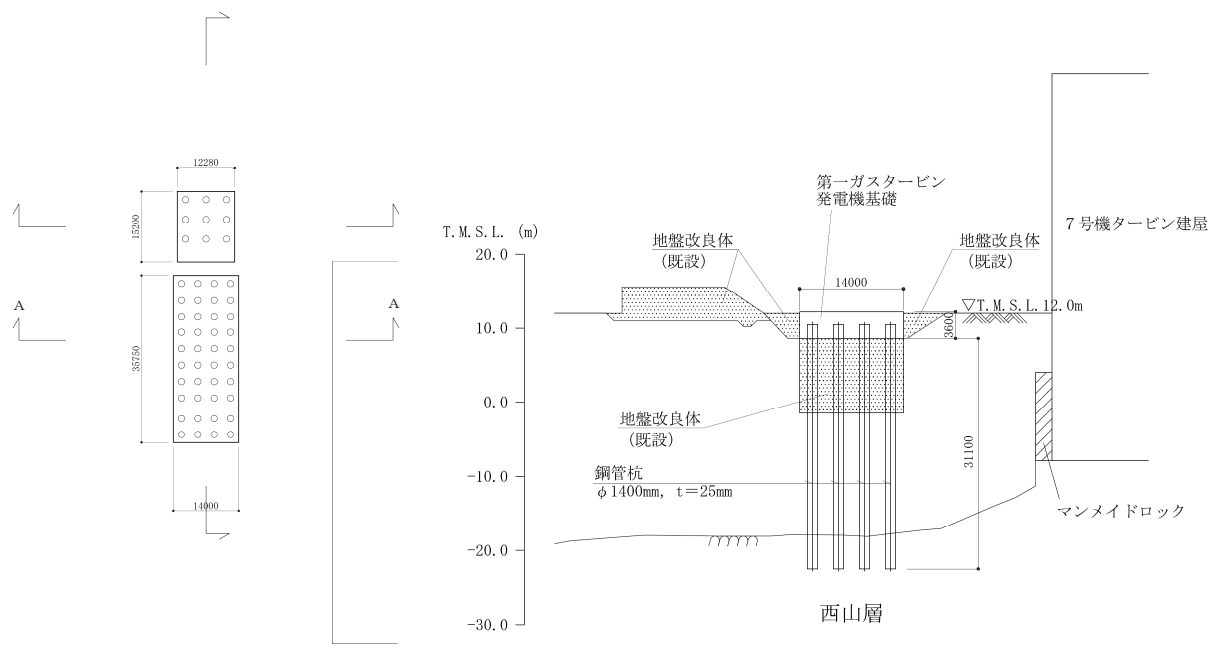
常設代替交流電源設備基礎の断面図 (A-A断面)
